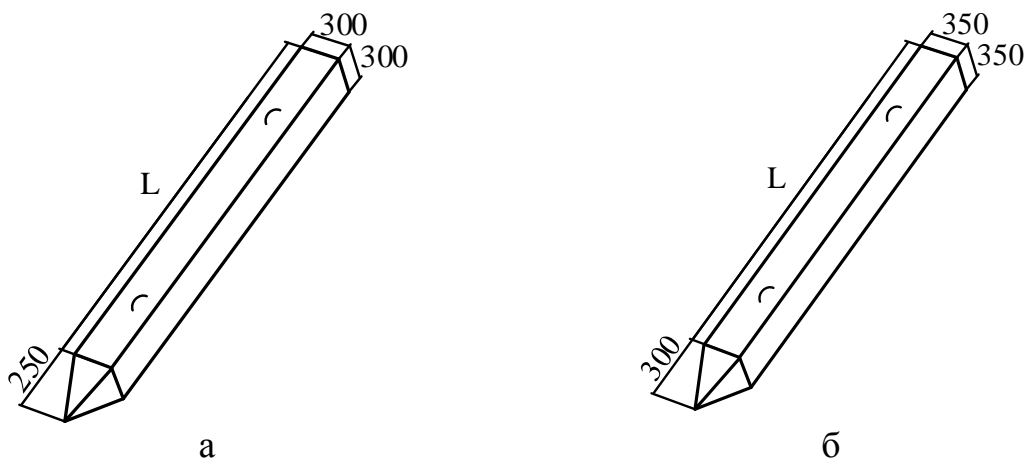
Сваи забивные железобетонные цельные, квадратного сплошного сечения с ненапрягаемой арматурой: а – сечением 300х300 мм; б – сечением 350х350 мм
